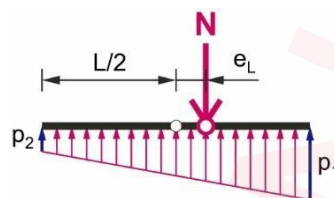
Distribuția presiunilor pe baza fundației acționată de o forță verticală cu excentricitate mică
